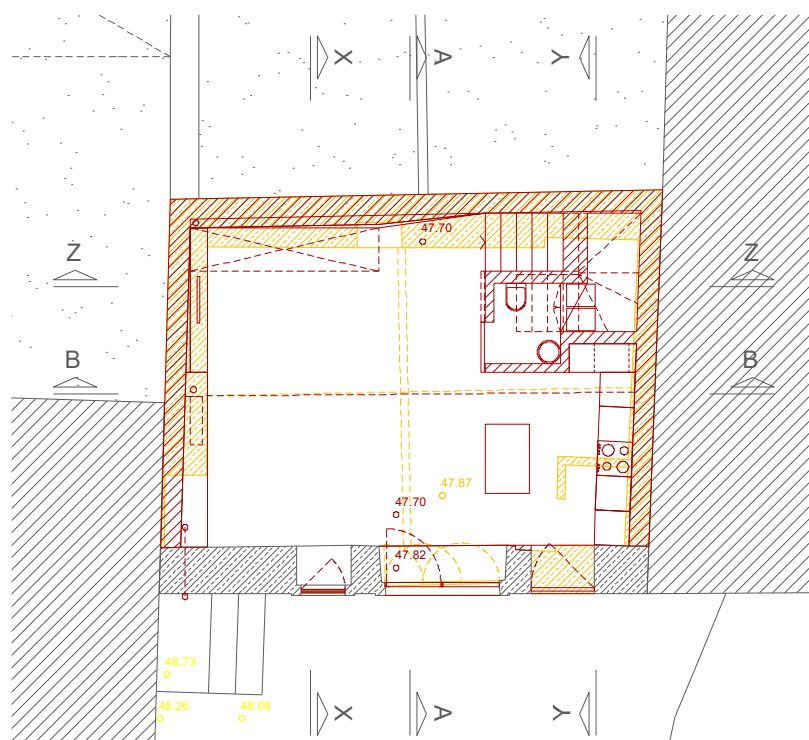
Planta de arquitetura de vermelhos e amarelos do Piso térreo
